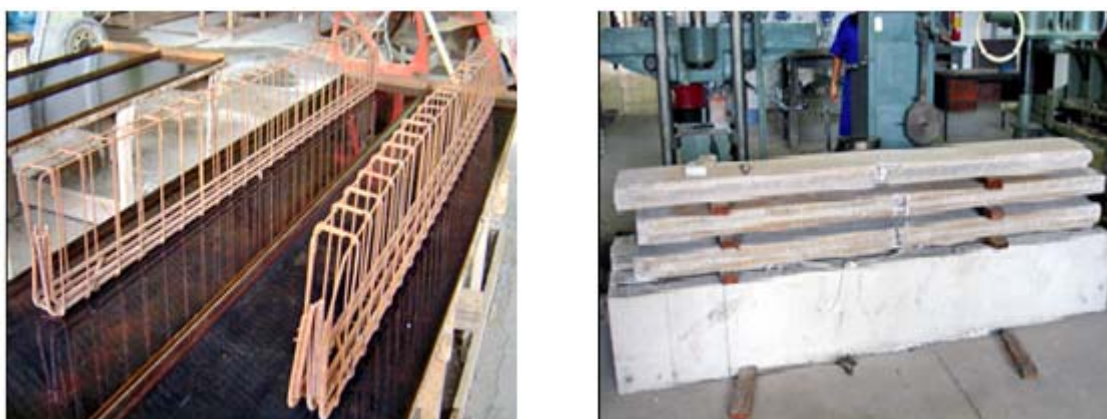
Forma metálica, armadura e vigas concretadas (SILVA FILHO et al., 2006)
